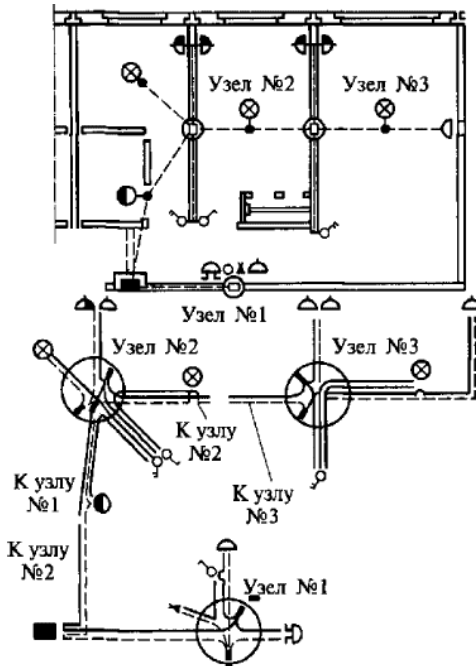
Пример технологической карты на монтаж электропроводки освещения, прокладываемой в каналах строительных конструкций здания
